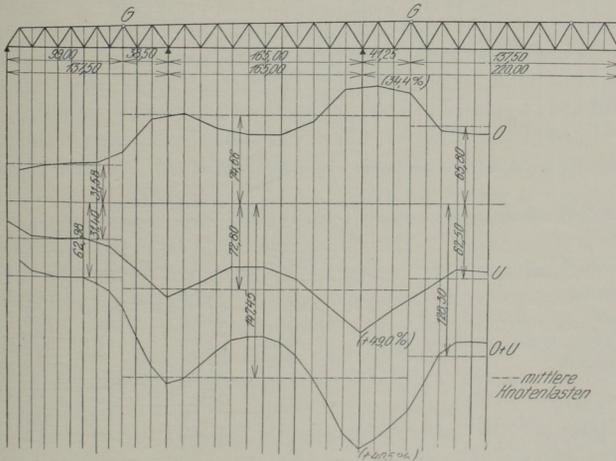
Verteilung des Eigengewichtes eines durchlaufenden Gelenkträgers auf 6 Stützen. Ausführungsentwurf der Brücke über den kleinen Belt
